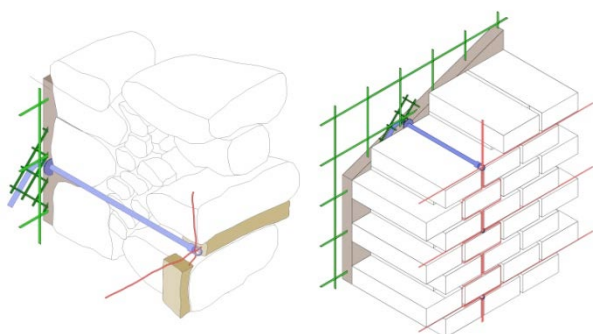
Schematizzazione del rinforzo ibrido con "Reticolatus" e intonaco armato con rete in GFRP su murature irregolari (sinistra) ed in laterizi (destra).
